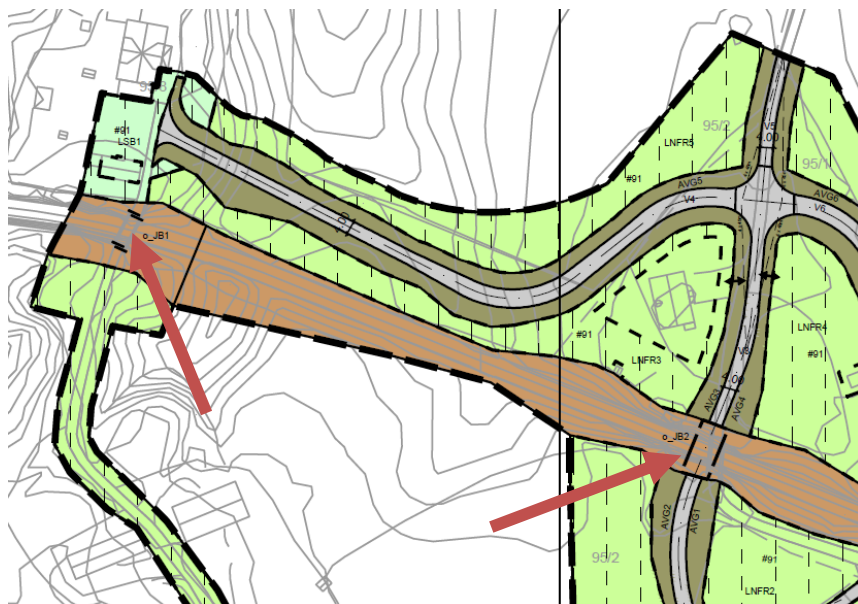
Planlagt veiløsning i vestre del av planområdet. Punkt 5 viser plassering av passeringslomme.
